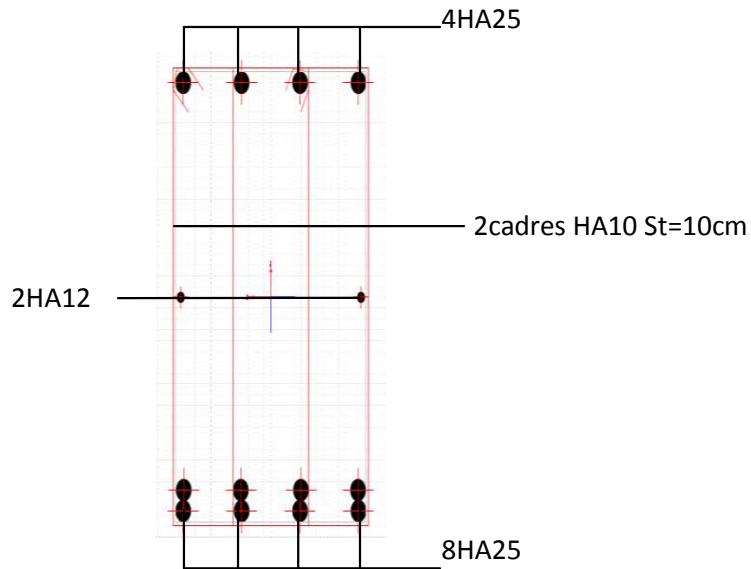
schéma du ferrailage d'une poutre en travée
